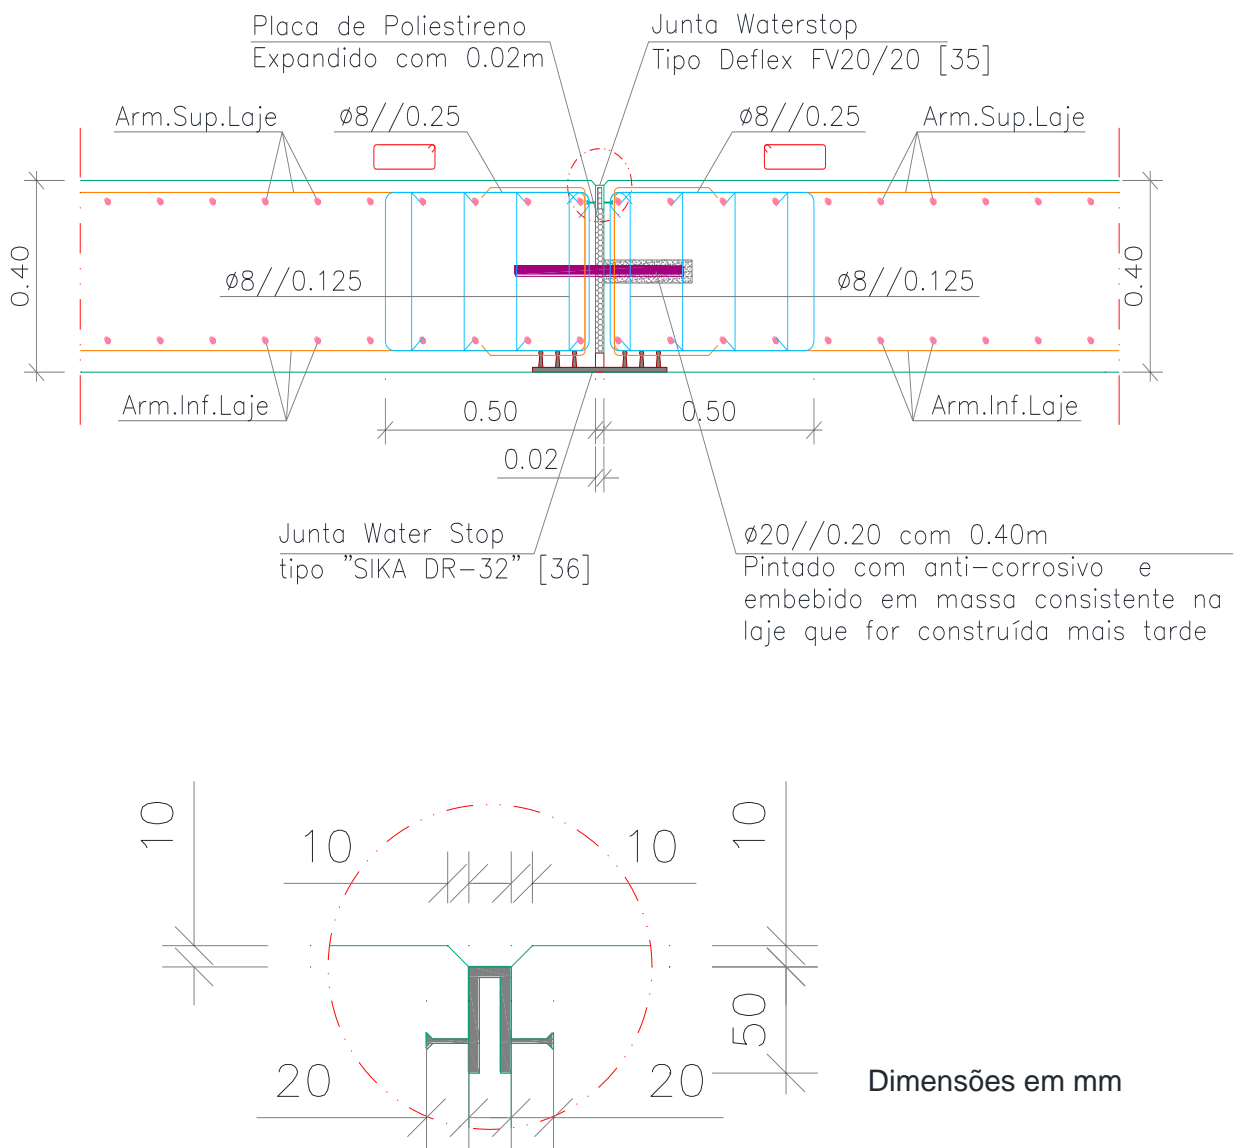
Pormenor da junta de dilatação na laje de fundo.
